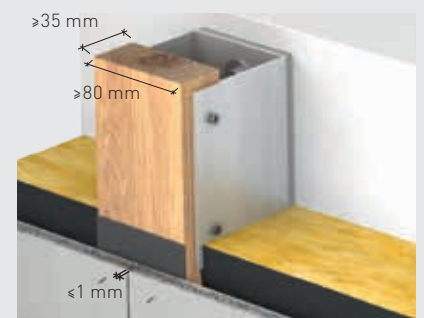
Plattenfuge dicht gestoßen (Fugenbreite ≤ 1 mm) bei Putzbeschichtung
